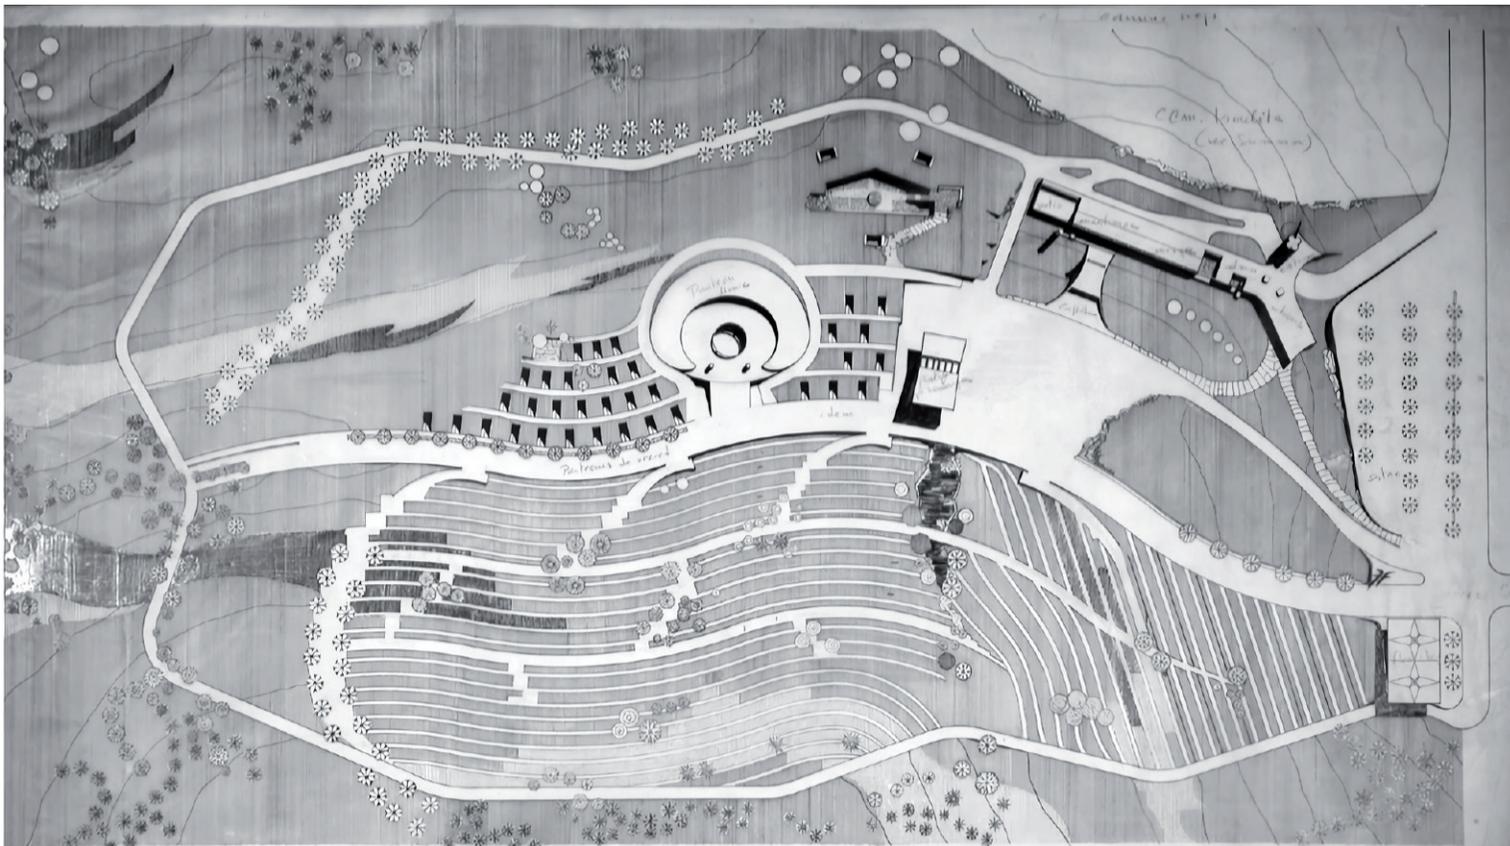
Horacio Baliero y Carmen Córdova, planta de conjunto, propuesta Concurso Nacional Cementerio de Mar del Plata, 1961. Dibujo técnico en tinta negra. Archivo Dar Digital Universidad de Buenos Aires.
